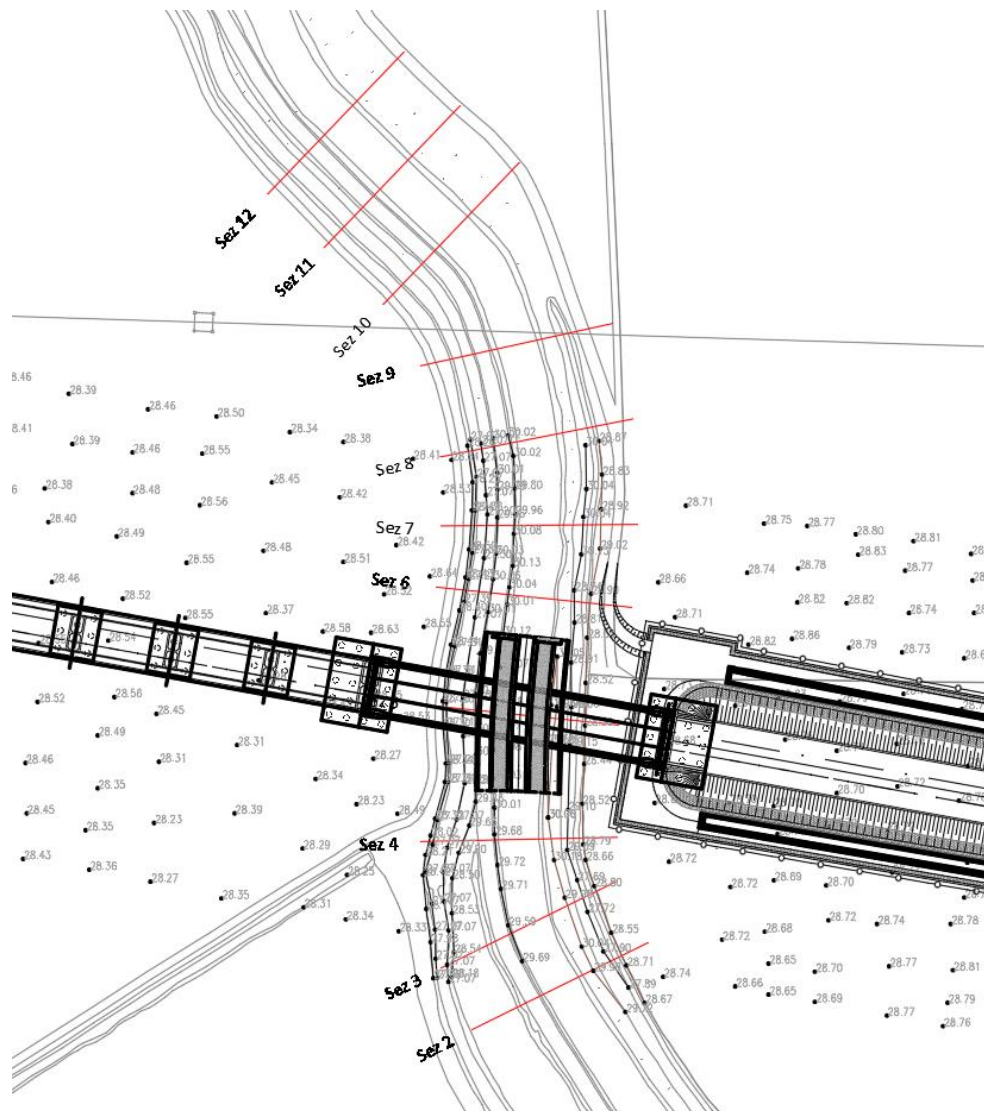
Torrente Fibbio– Stralcio planimetrico stato di progetto con l’indicazione delle sezioni.
